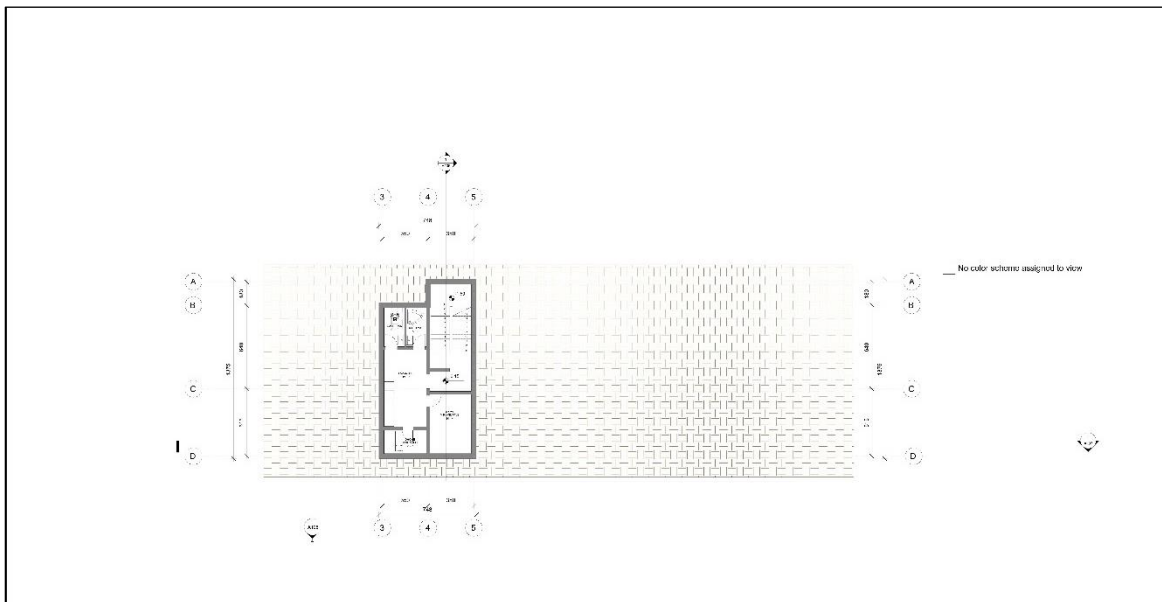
Planimetria e Propozuar e Katit Nëndhe [-1]
